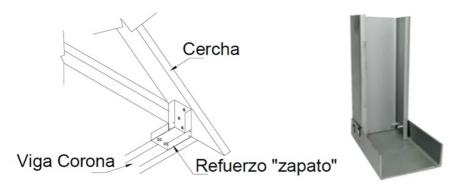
Refuerzo tipo zapato, unión cercha-viga corona
